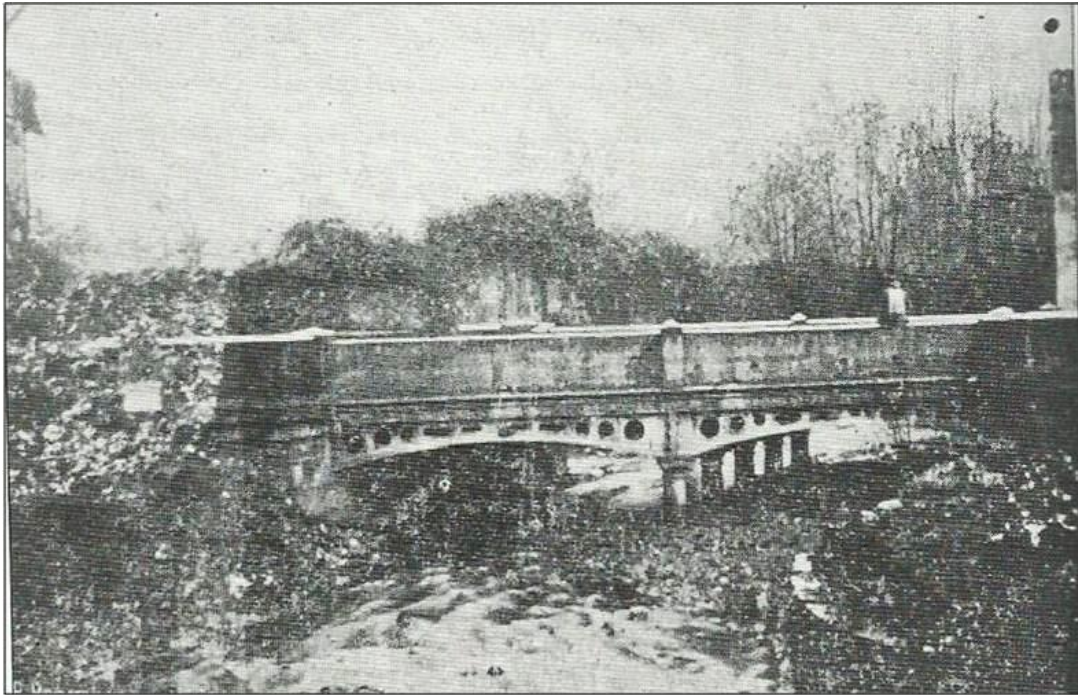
Lámina del puente de Ciaño reproducida en la obra Hormigón y Cemento Armado: mi sistema y mis obras. 1902
